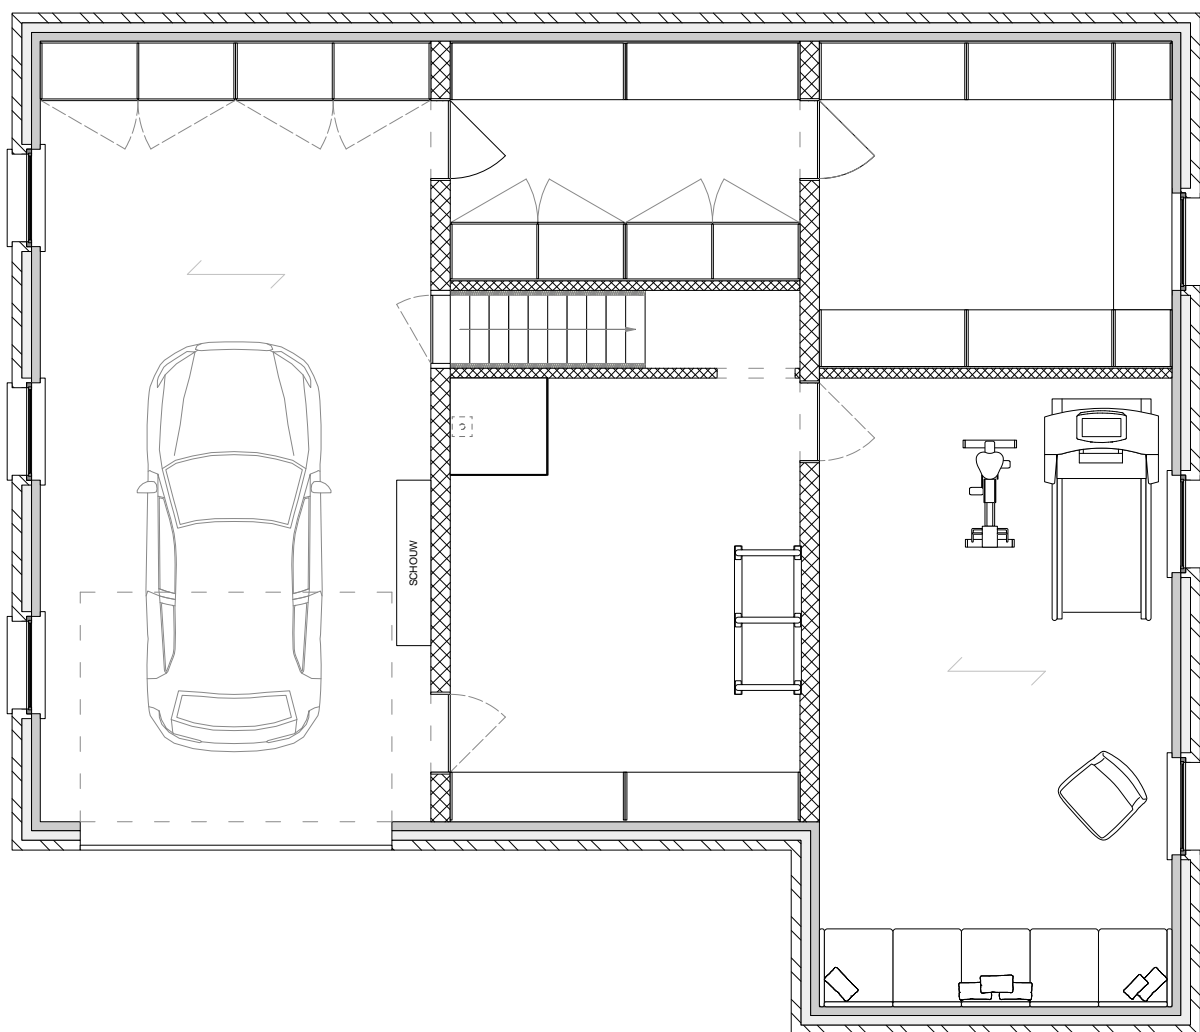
grondplan 0 zomer situatie (eigen plan)
